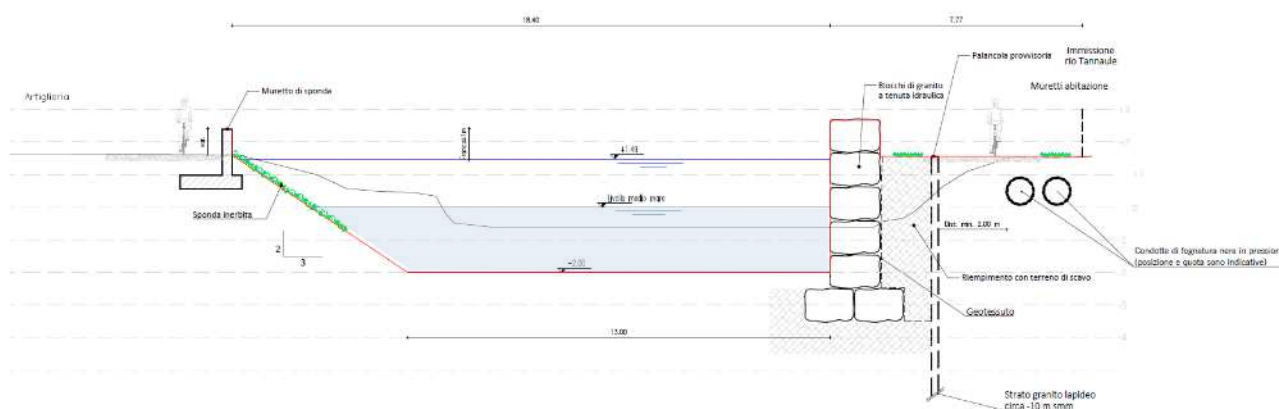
sezione di progetto nel tratto di foce del rio Seligheddu con muretto di protezione lato Artiglieria e muro a parete verticale in blocchi di granito in dx
